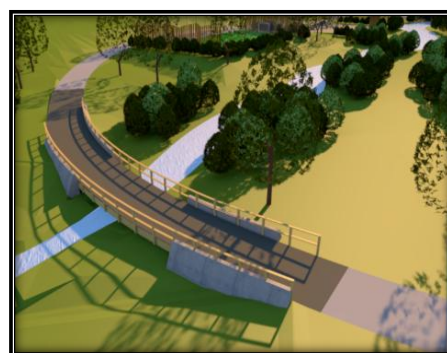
Exemples de passerelles traversant des cours d'eau
